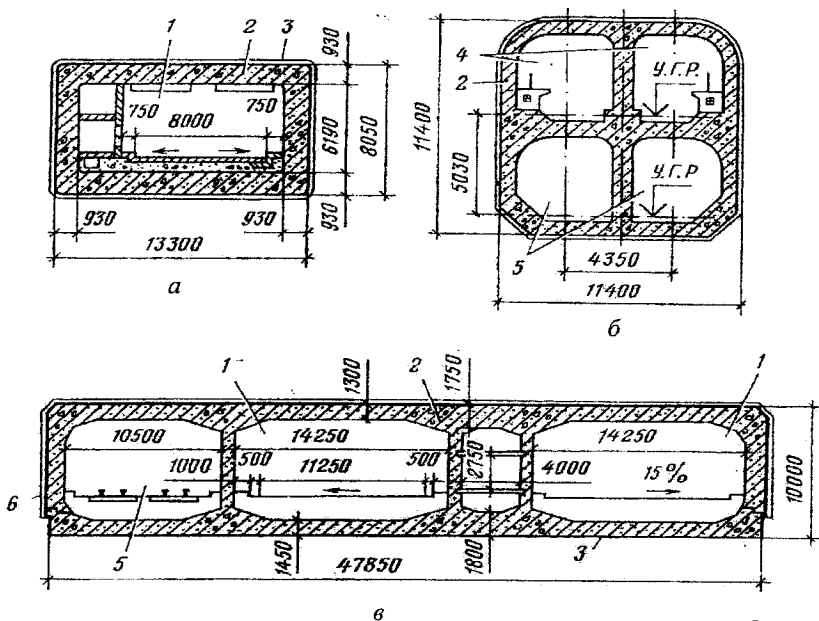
Конструкції тунельних секцій прямокутного поперечного перерізу із залізобетону:
